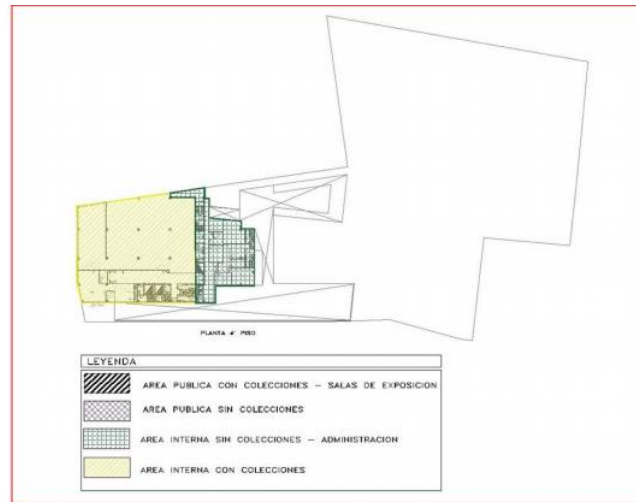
Planta 4to Piso. Fuente: Equipo consultor.
